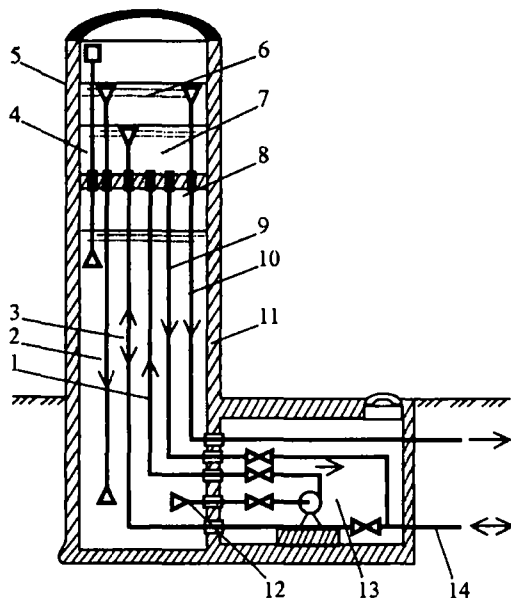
Схема оборудования водонапорной башни-колонны:
